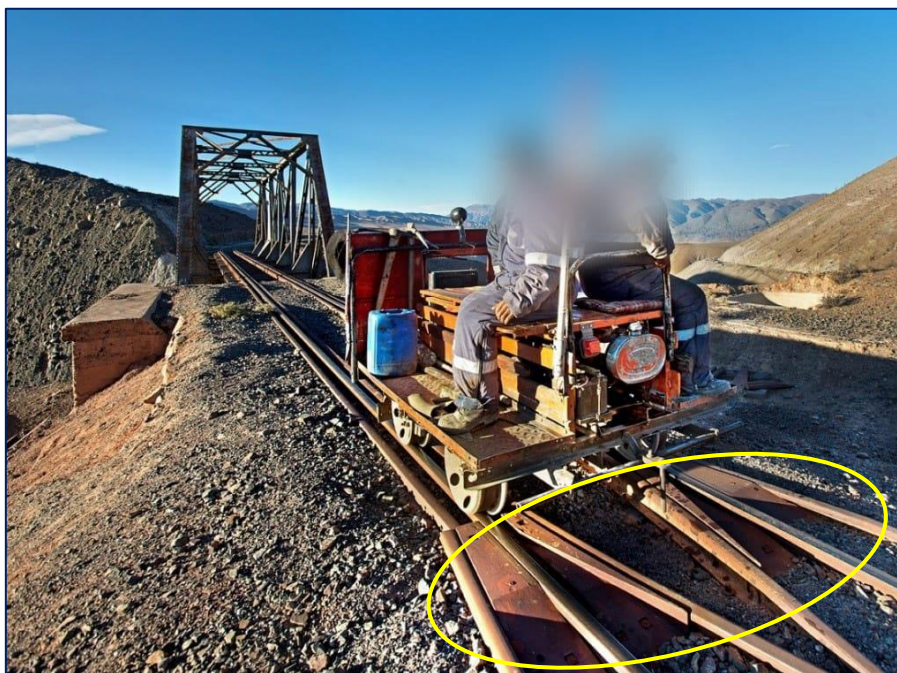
Dispositivo encarrilador en el ramal C14 del Tren a las Nubes.
